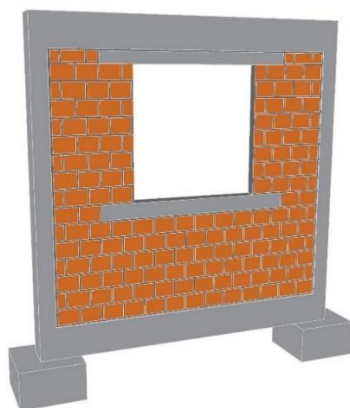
Modelo da parede menor em concreto armado e alvenaria com janela.
